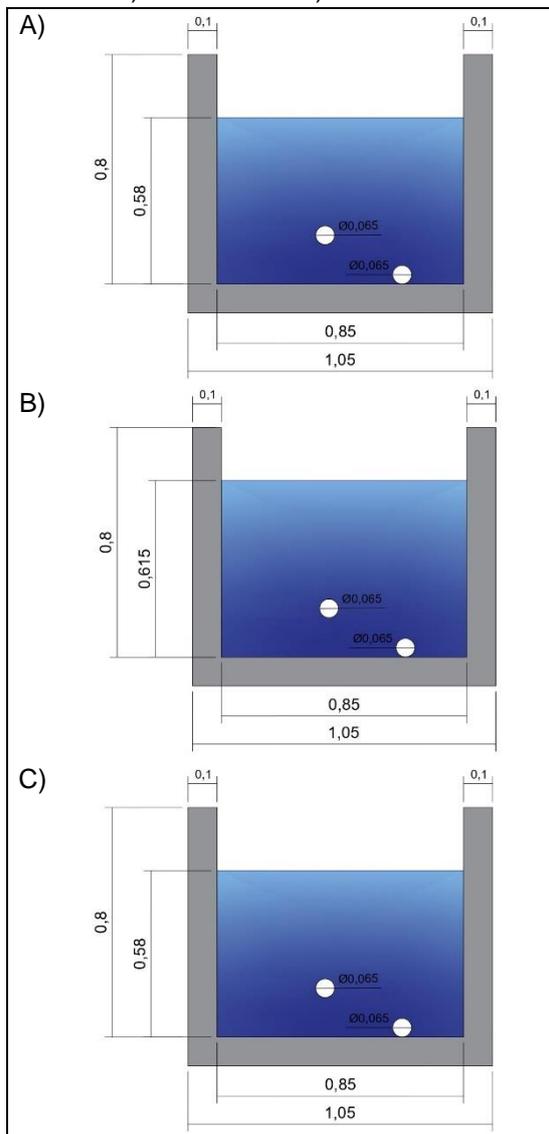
Corte longitudinal “B” da planta baixa da captação. A) 26/02/2023. B) 12/03/2023. C) 26/03/2023.
